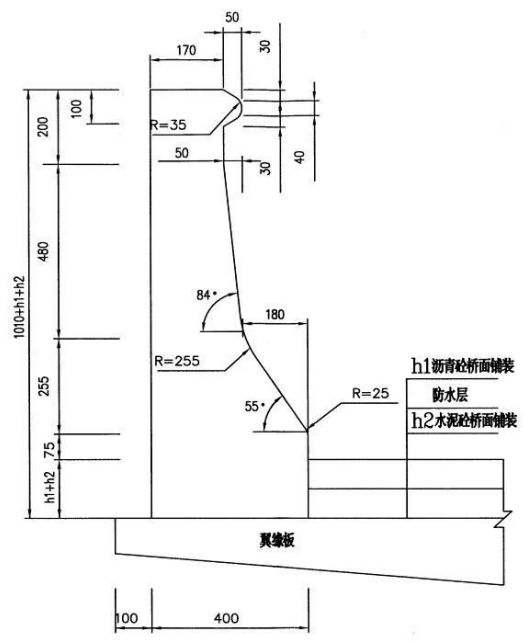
桥梁防撞栏横断面图 单位：cm
